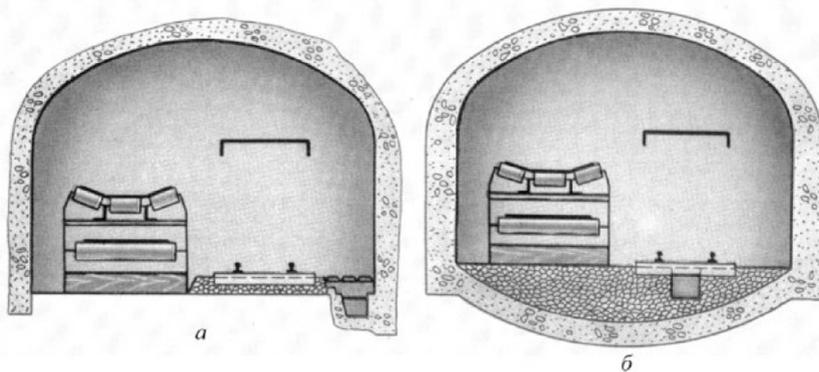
Бетонная крепь с вертикальными стенами и сводчатым перекрытием (а) и с обратным сводом (б)
